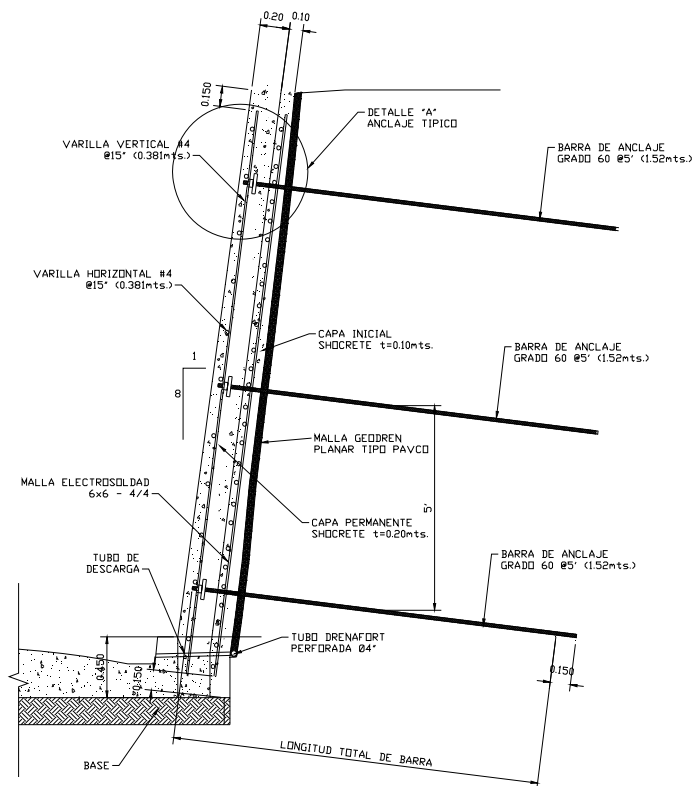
28 Detalle de muro de tierra armada o soil nailing, del proyecto en estudio. Anclajes distribuidos @ 1.5m.
